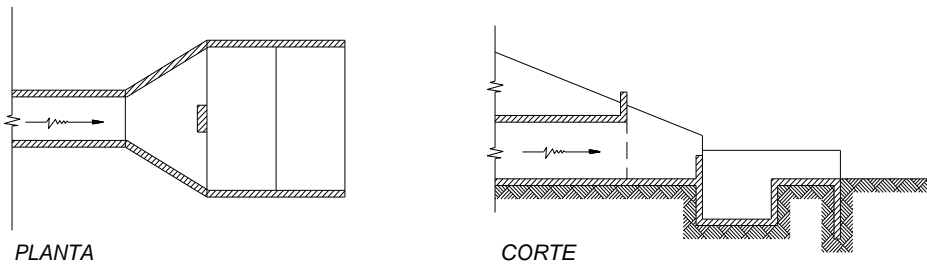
Terminal de alcantarilla con batea de gaviones
